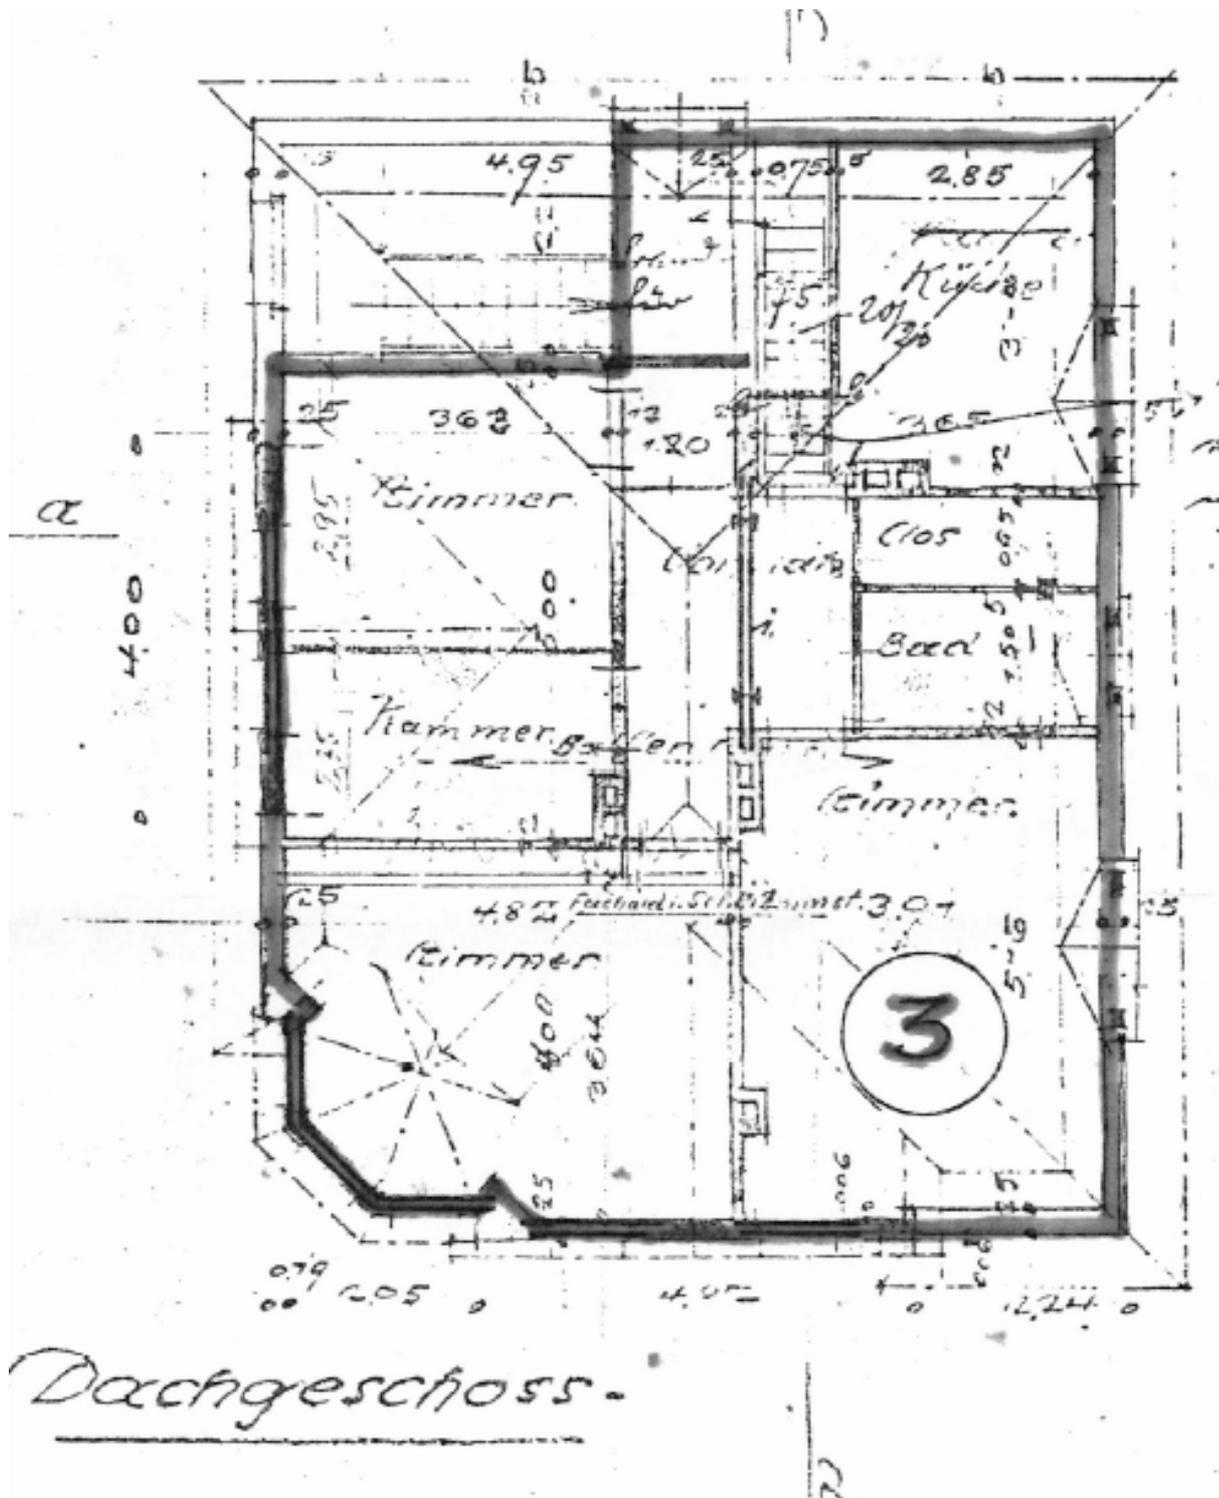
Grundriss Dachgeschoss Wohnung Nr. 3 (ohne Maßstab); Quelle: Grundakte des Grundbuchamts Wiesbaden; Aufteilungspläne zur Bescheinigung vom 11.11.1983
